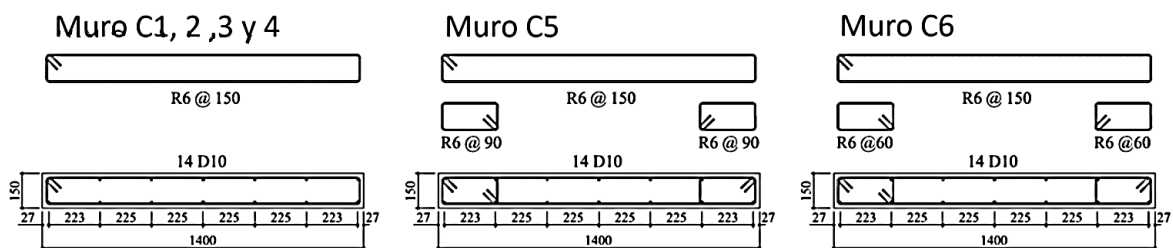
Secciones transversales de muros ensayados por Lu [23].
